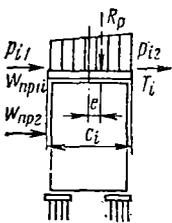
Схема вертикальных и горизонтальных нагрузок на перекаточную опору
